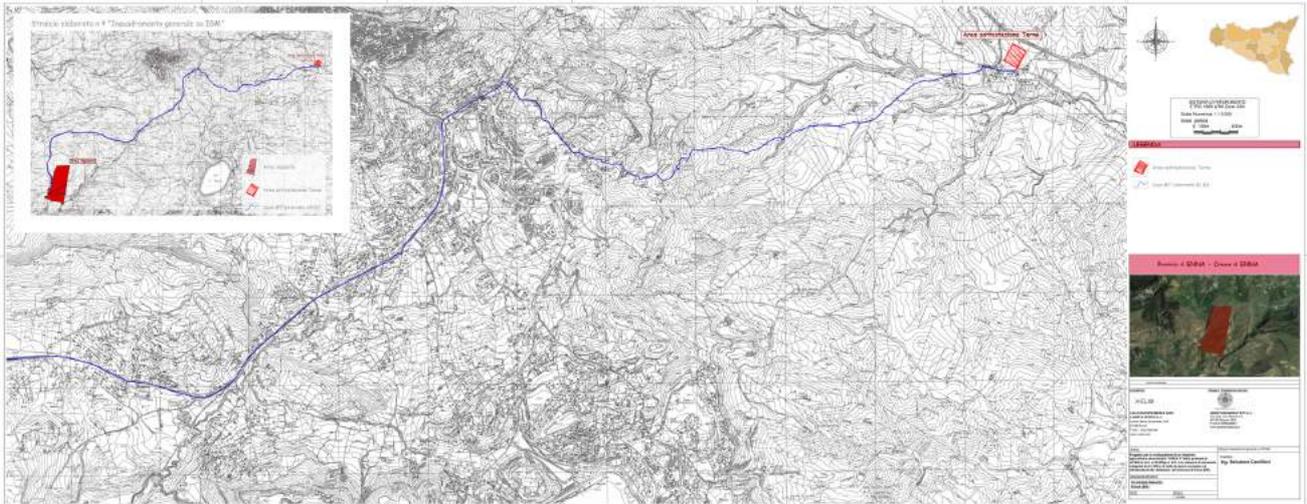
Layout complessivo Impianto e connessione su CTR
